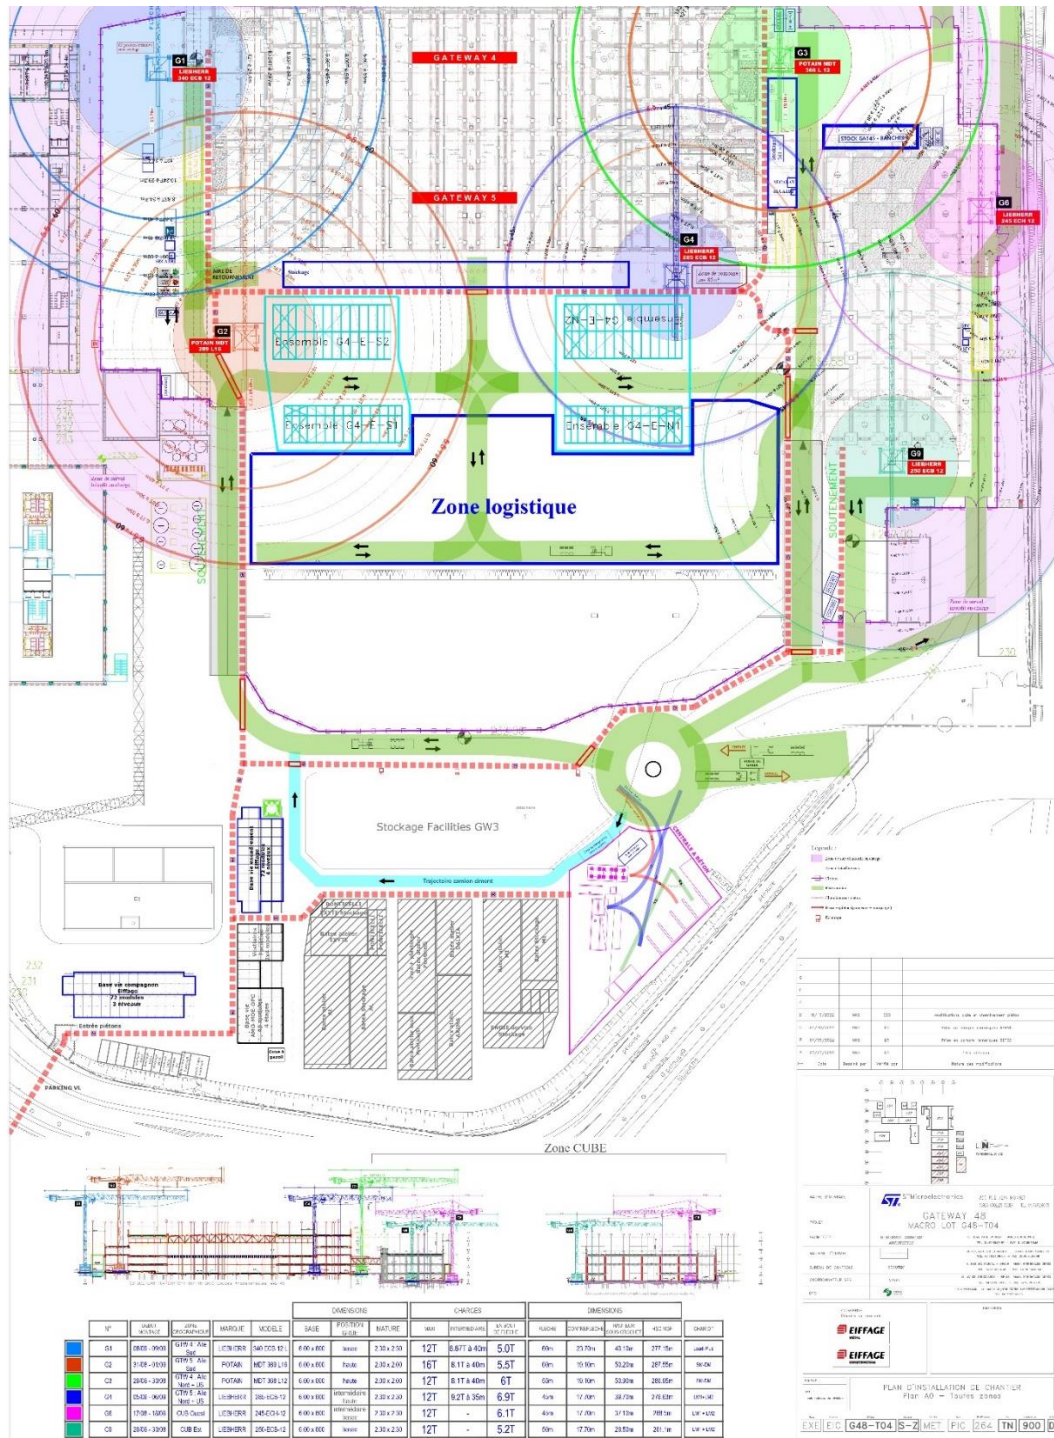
PLAN DES INSTALLATIONS DE CHANTIER POUR LA PHASE 1 DU CHANTIER (GW 4-6)
